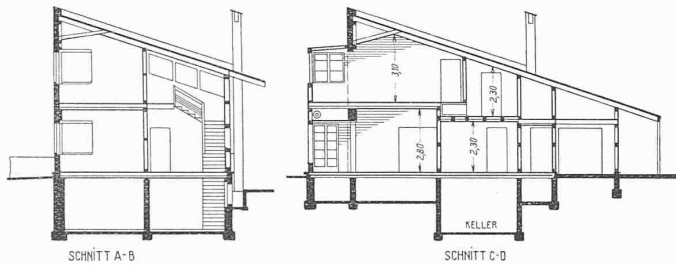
bis 5. Grundrisse und Schnitte. — Masstab 1 : 300.
